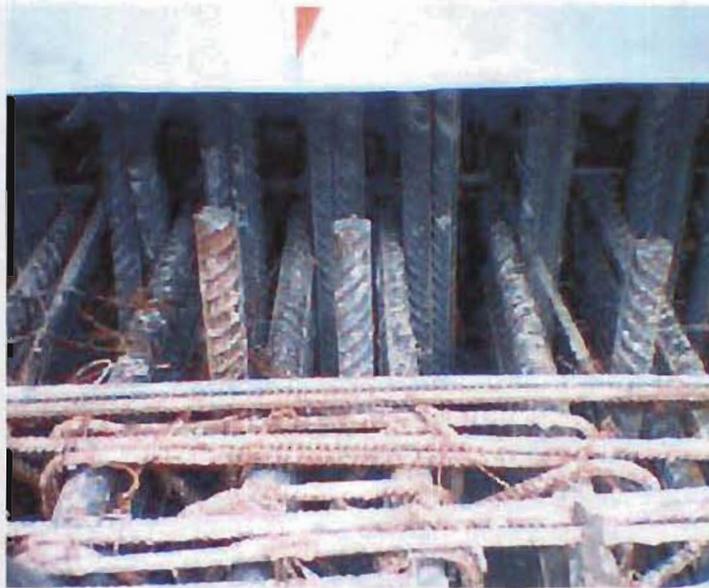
Penetración del acero de la columna en el candelerio.
